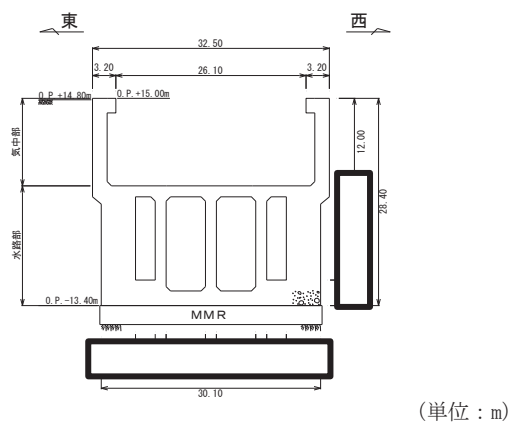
海水ポンプ室断面図 (B-B 断面, 東西)
